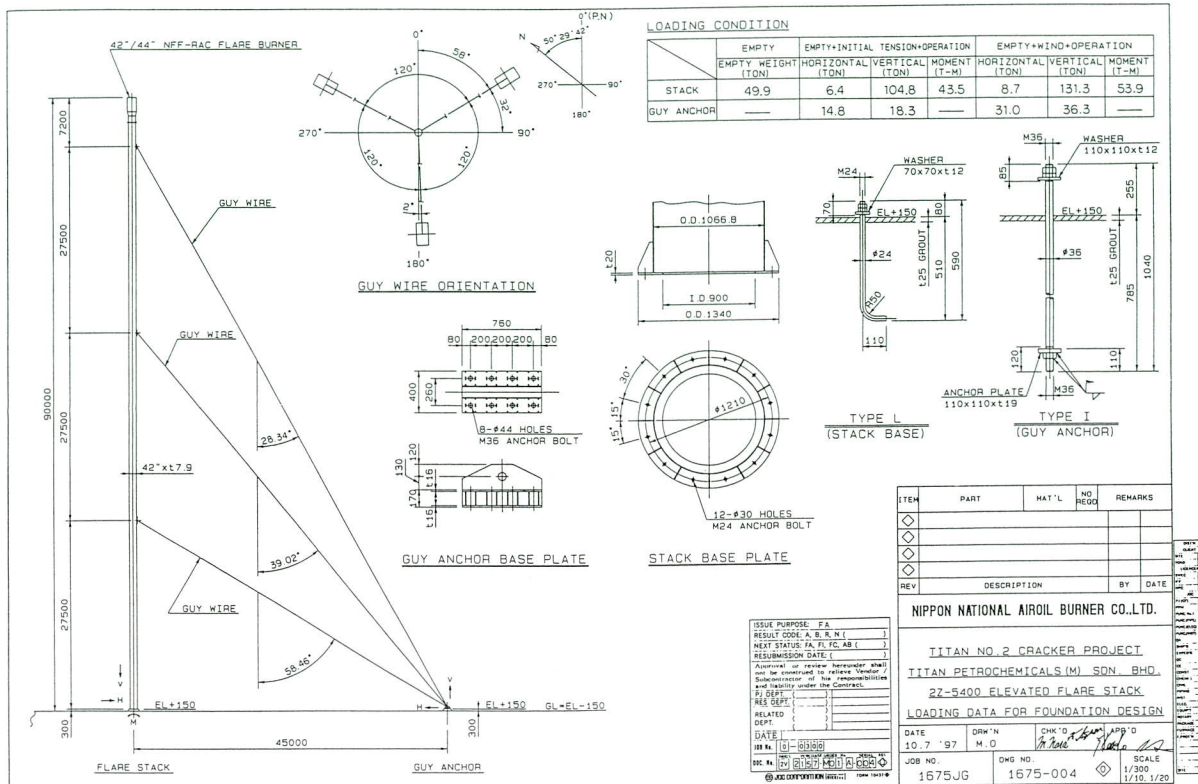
基礎図の例 (TITAN No.2 CRACKER PROJECT)
